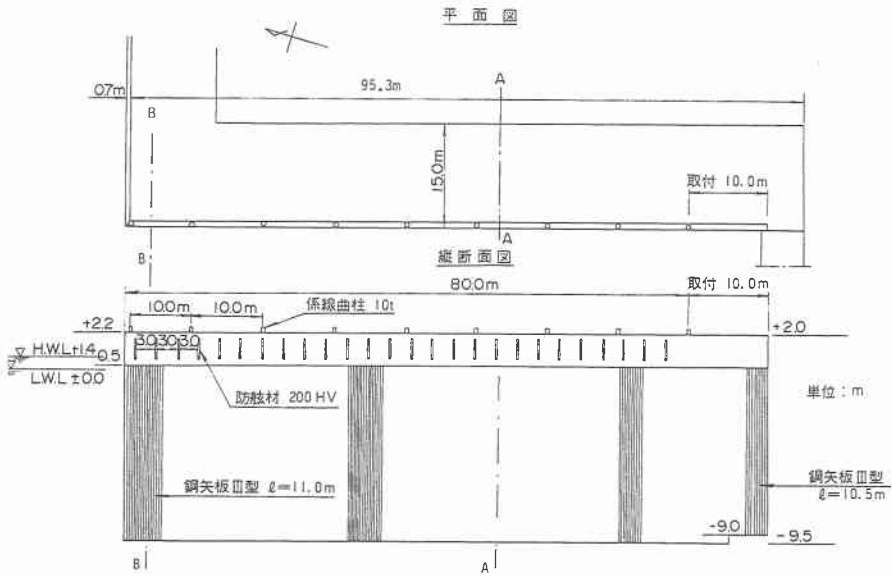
森港中央埠頭-4.5 m 岸壁平面図・縦断面図
